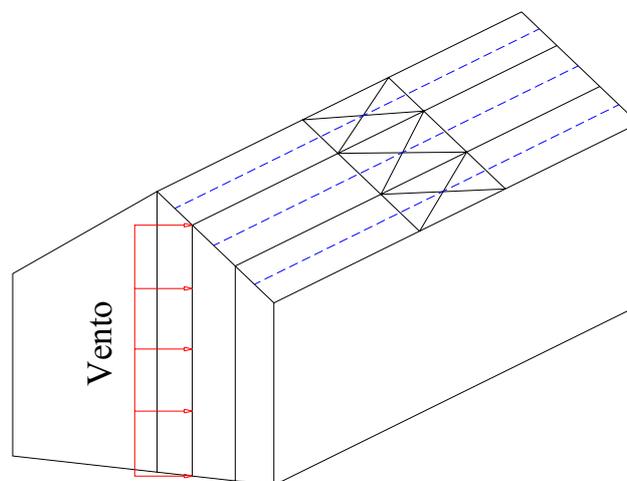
Contraventamentos dos pilares de empena efectuados com transmissão pelas madres
